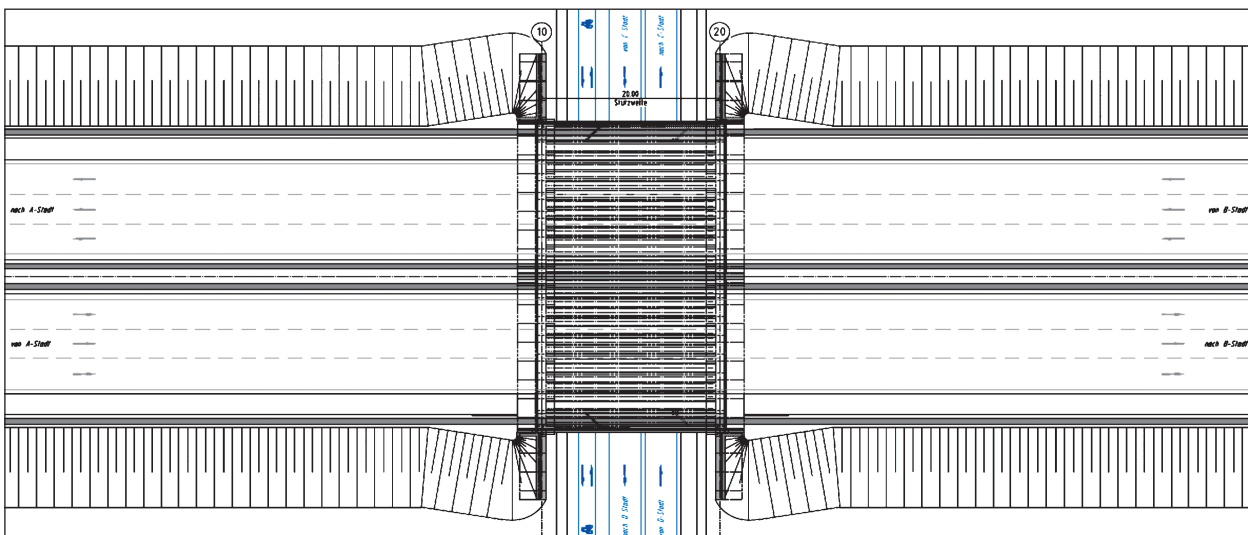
Grundriss Bauwerk 2 Einfeldsystem von 10 m – 30 m
